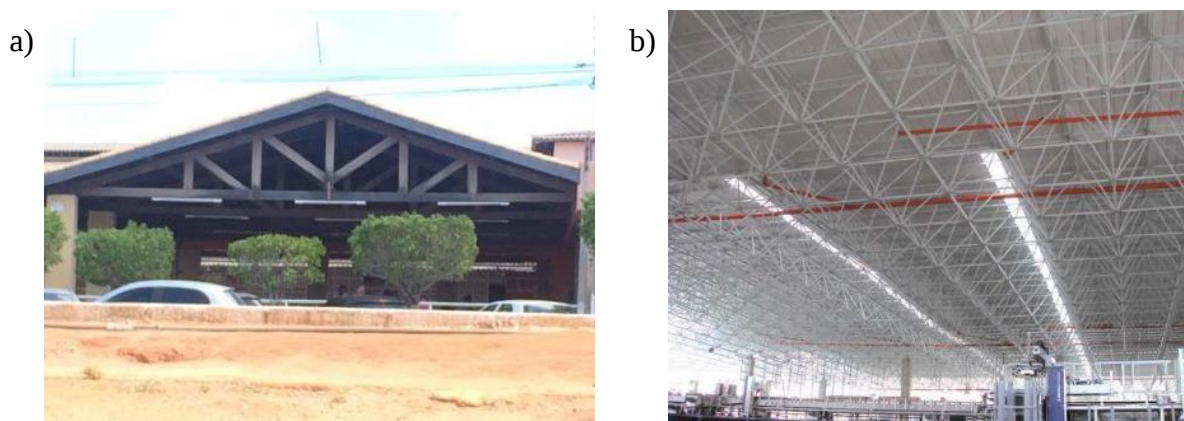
Aplicações de a) treliças planas e b) treliça espaciais.
